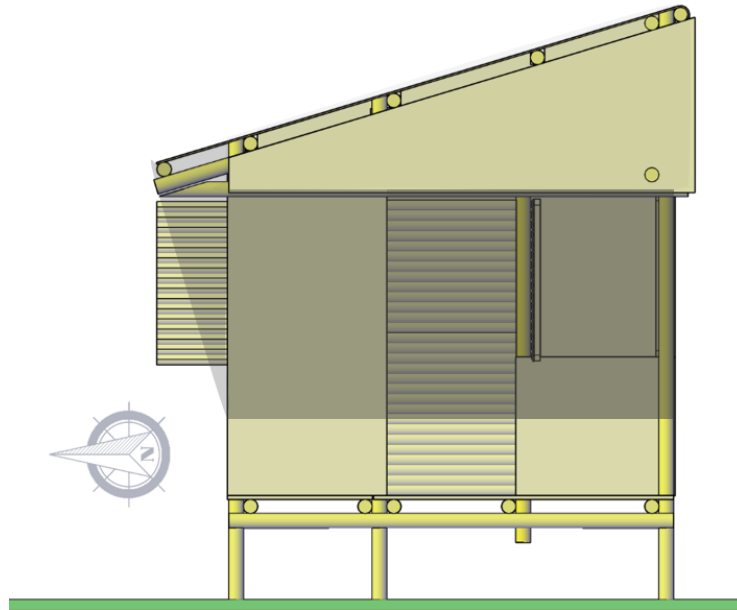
Sombra generada por alero de cubierta y retroceso en fachada Este- Oeste. Fuente: Elaboración Propia
